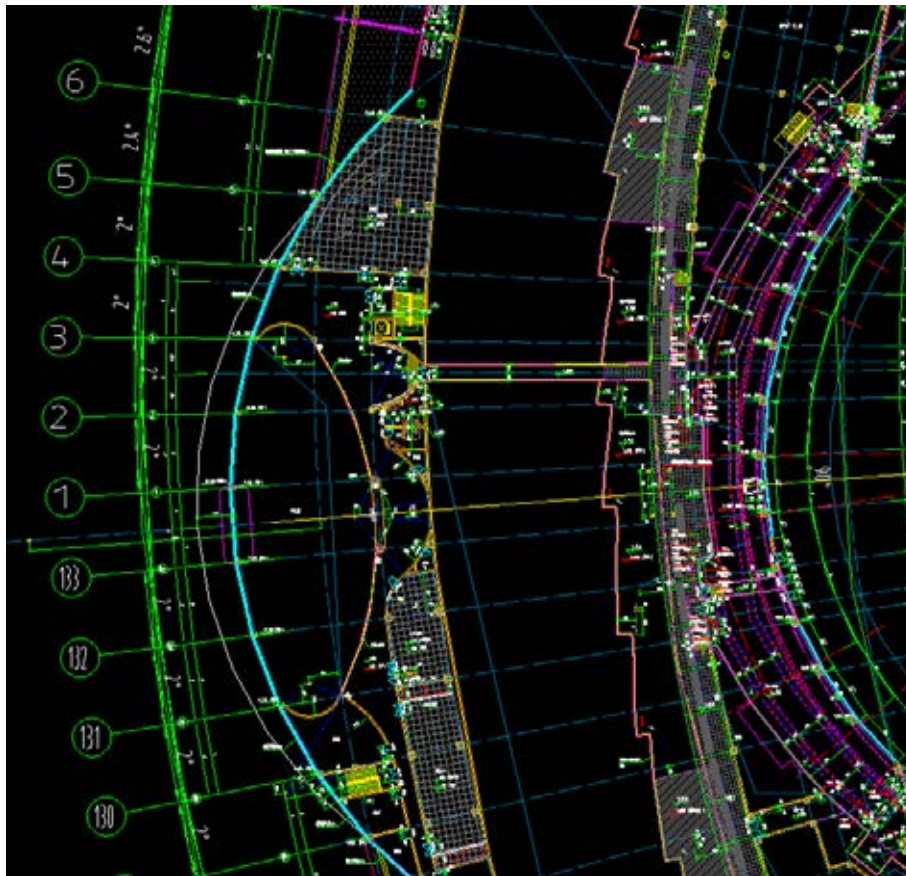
HEPS 二层平面图(门厅部分截图)
